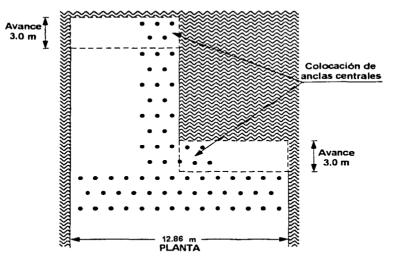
Colocación de concreto lanzado y anclajes en zonas centrales de la excavación.
